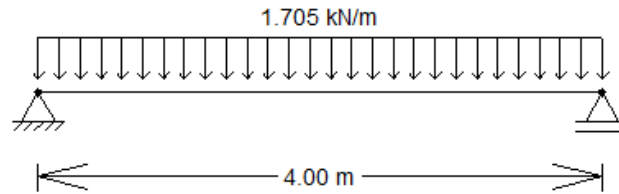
Sistema estático da viga 3 ou 4 com esforço transmitido da laje
